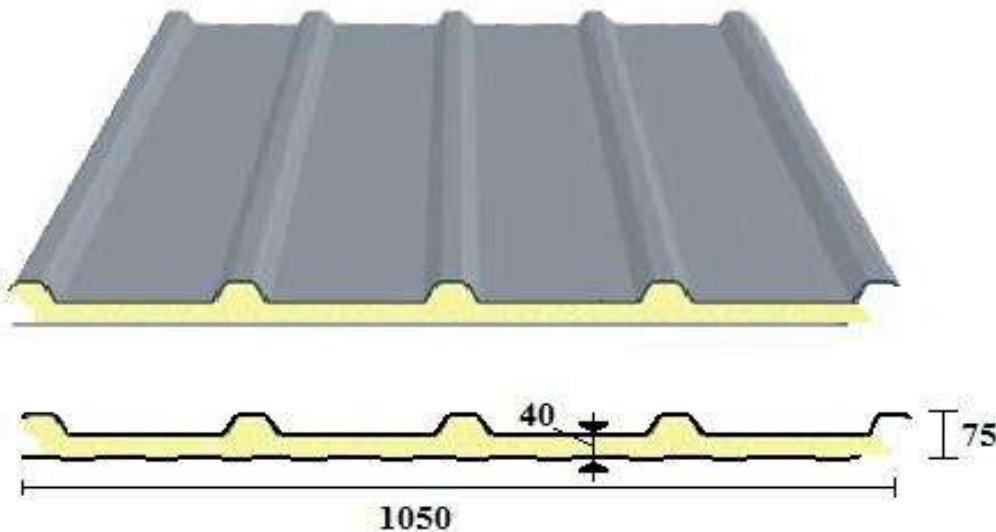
Panneau sandwich TL 75 P BATICOMPOS (Annexe 1)
